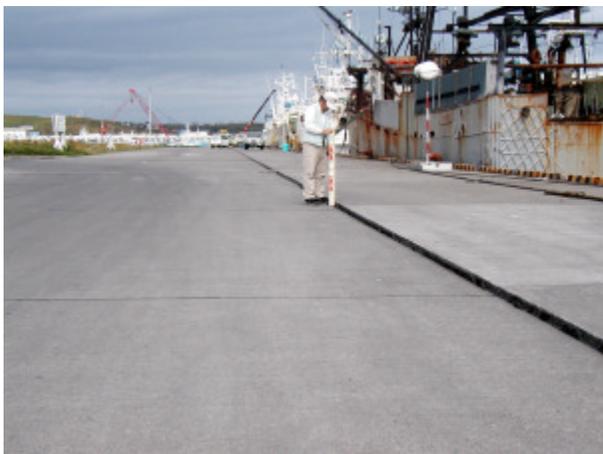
裏込め部の沈下（花咲港中央地区-5m岸壁）
